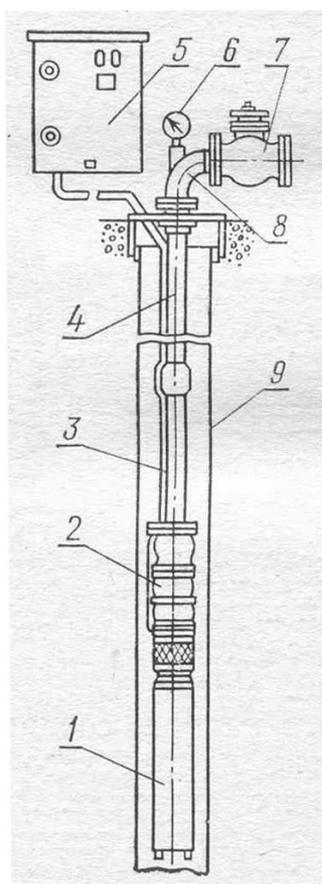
Схема размещения основного оборудования станции первого подъема
